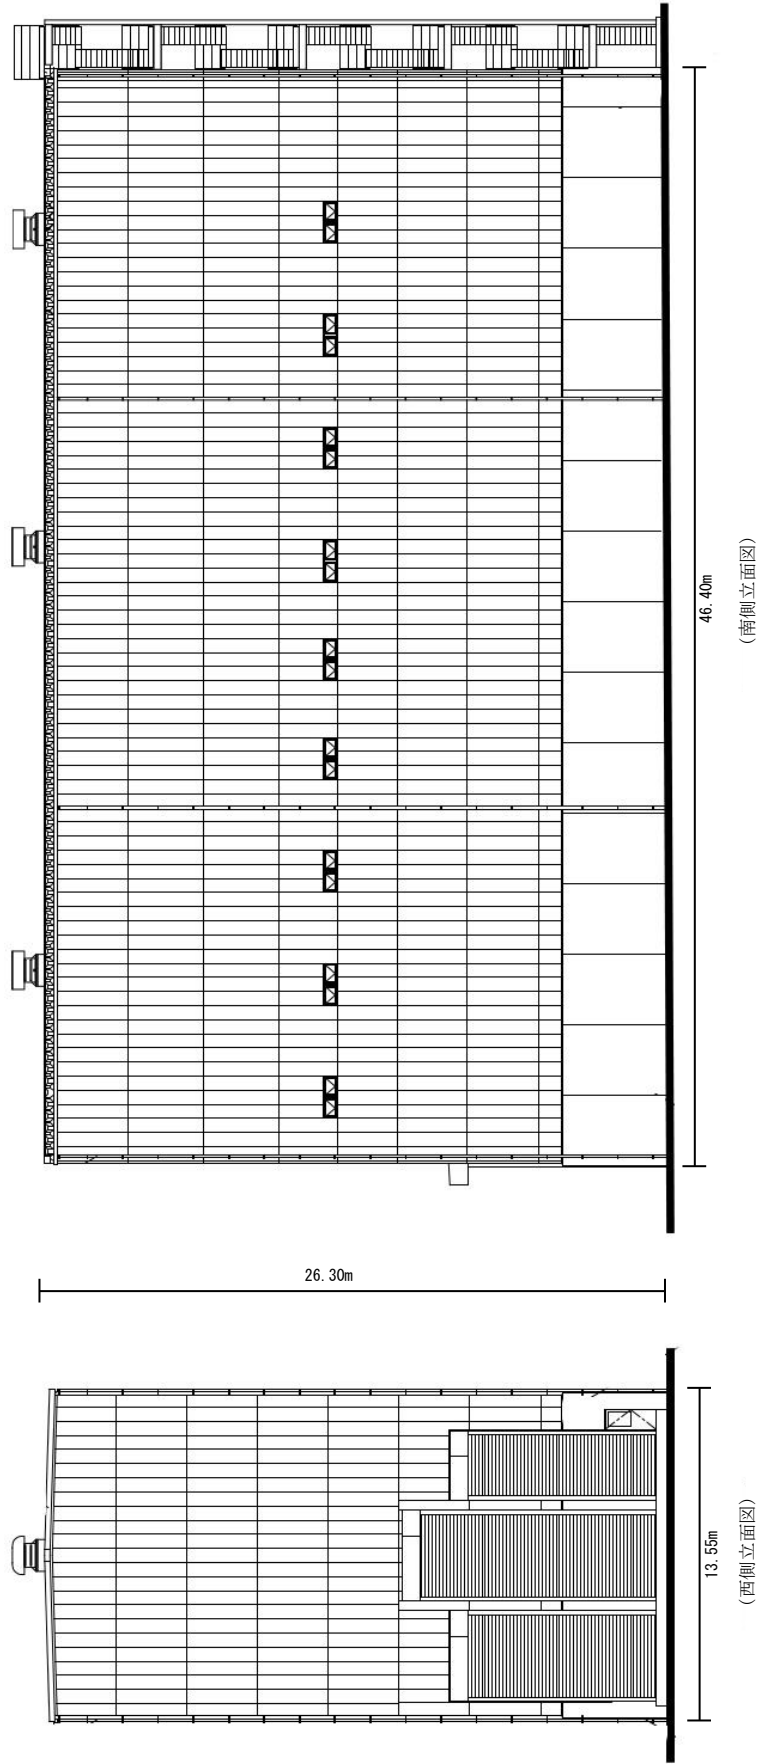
(2) 施設建屋立面图-1 (西・南立面)
